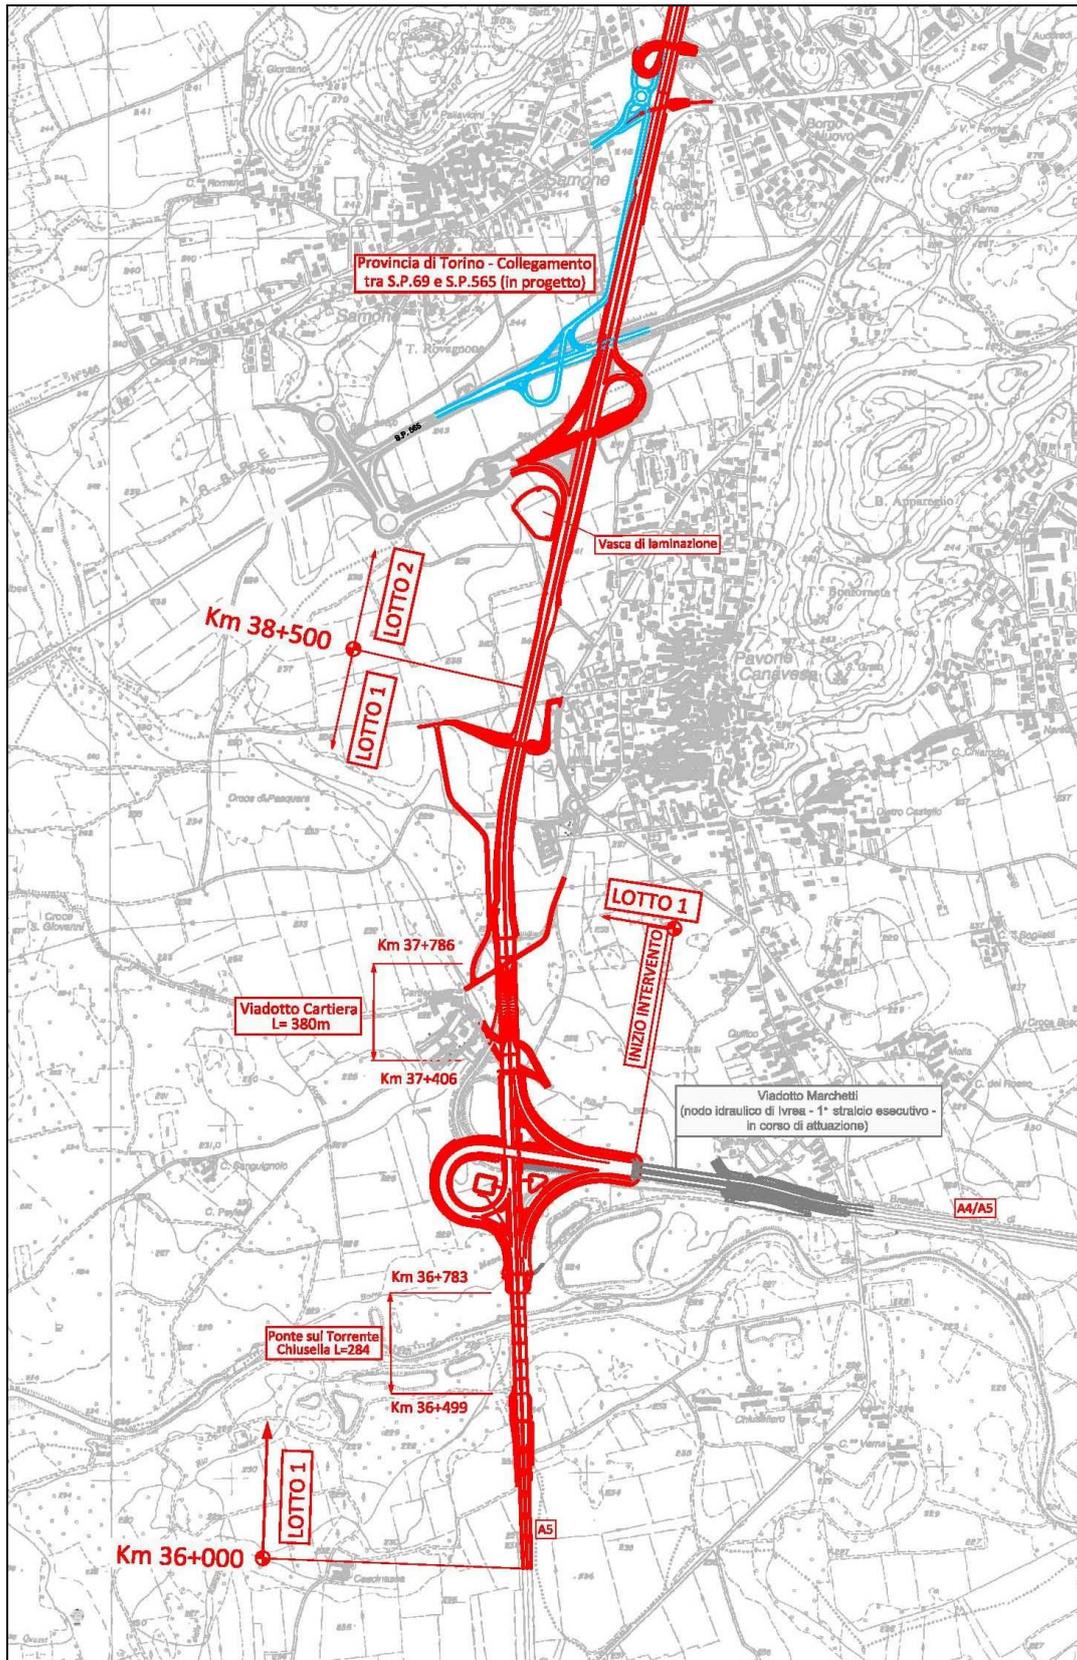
/1 Interventi in progetto – lotto 1 e lotto 2
